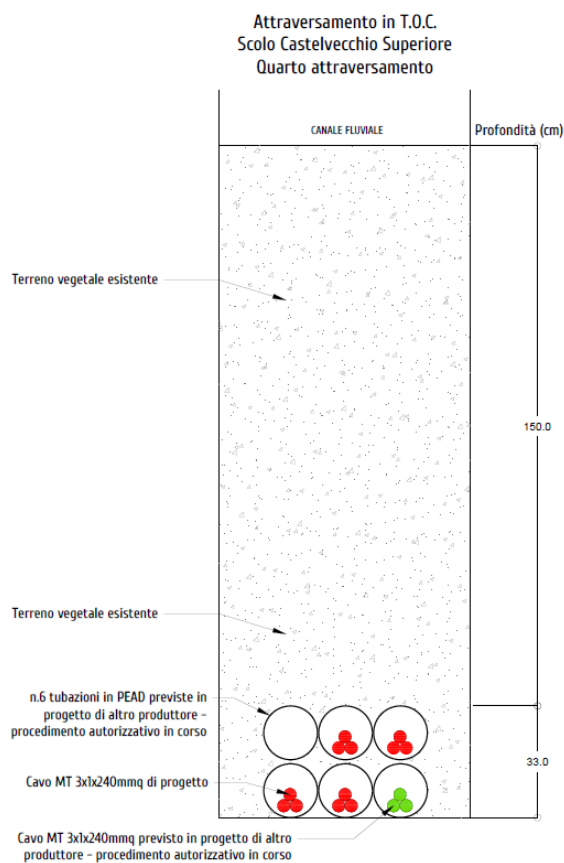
Sezione trasversale – Quarto attraversamento in T.O.C.
